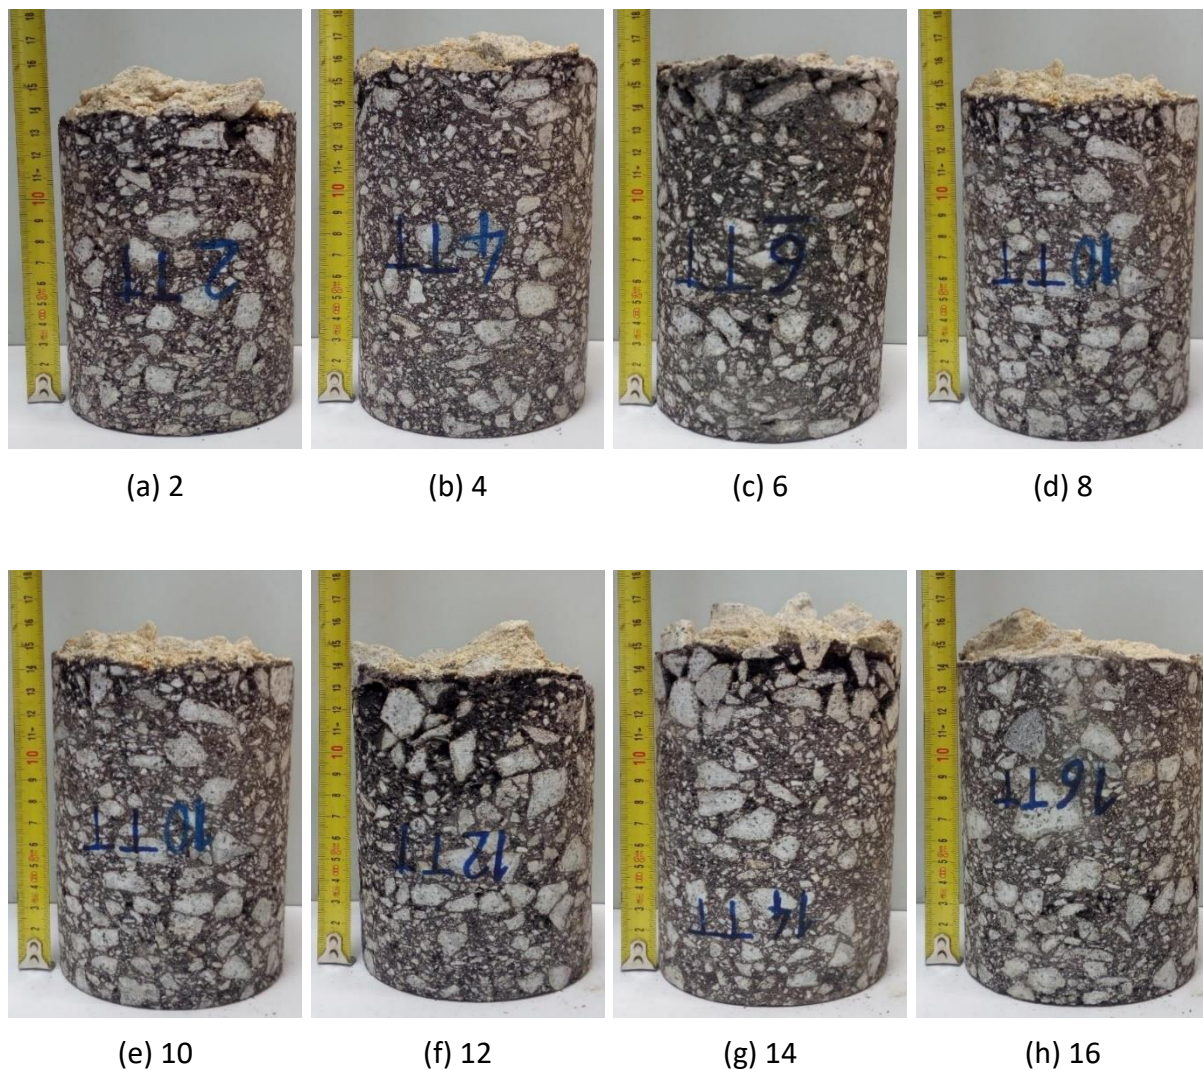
Conjunto de carotes extraídos da zona 2 do pavimento em estudo
